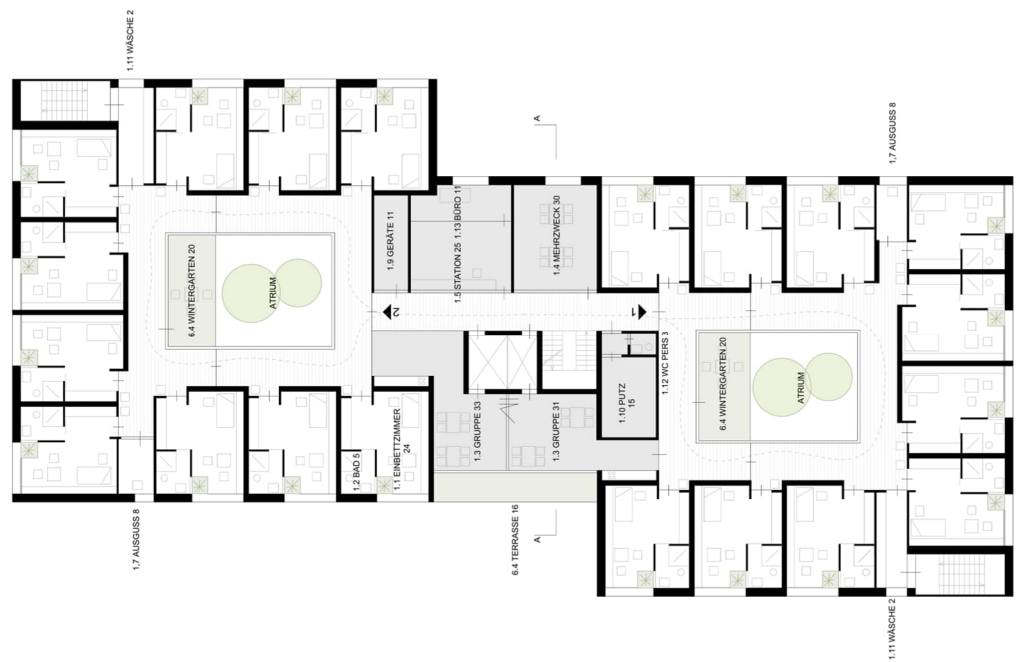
Grundriss Regelgeschoße (1. OG) LEMNISKATE (massstabslos)
